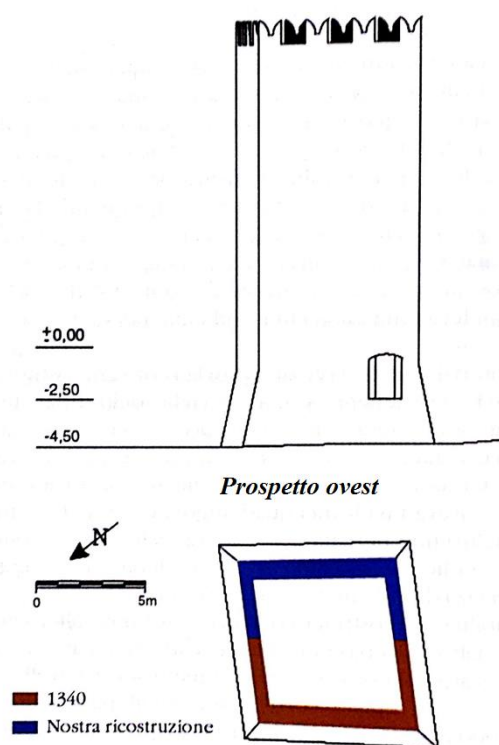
Prospetto e pianta prima torre d'avvistamento. Ricostruzione CDS
